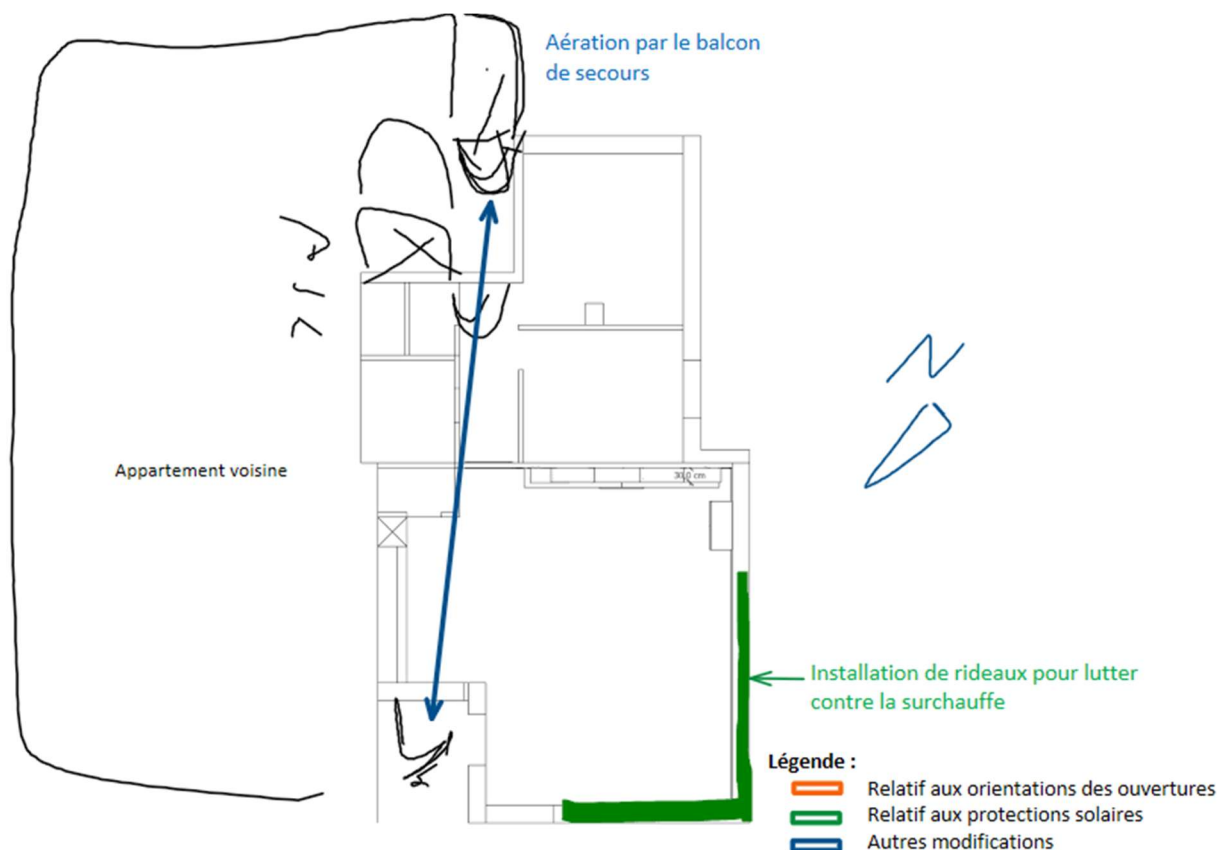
Architecte 3 : Logement 2 : Surchauffe
